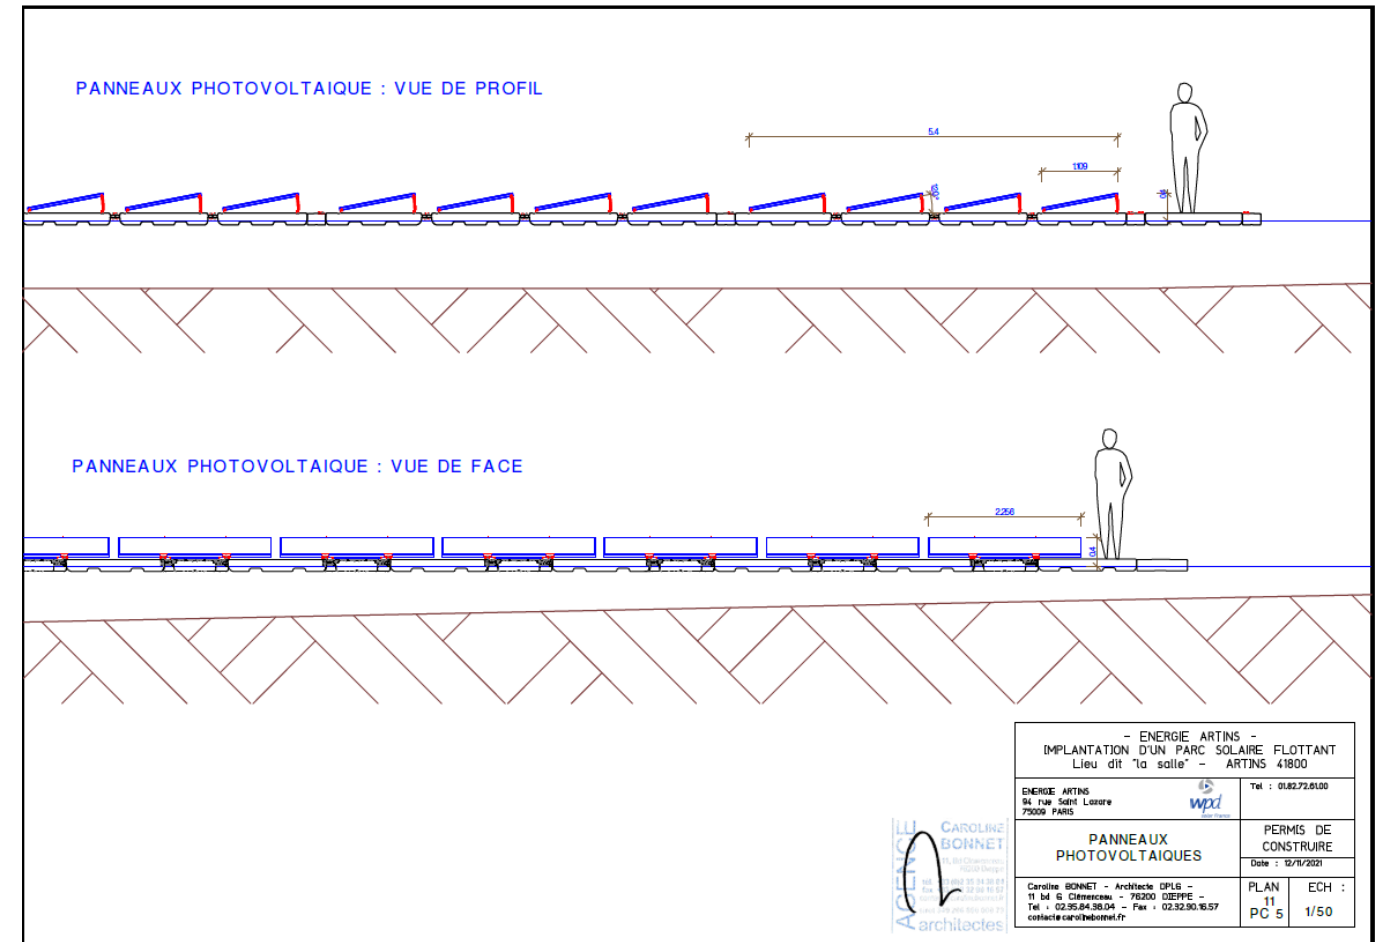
Plans de coupe et façades des tables photovoltaïques
